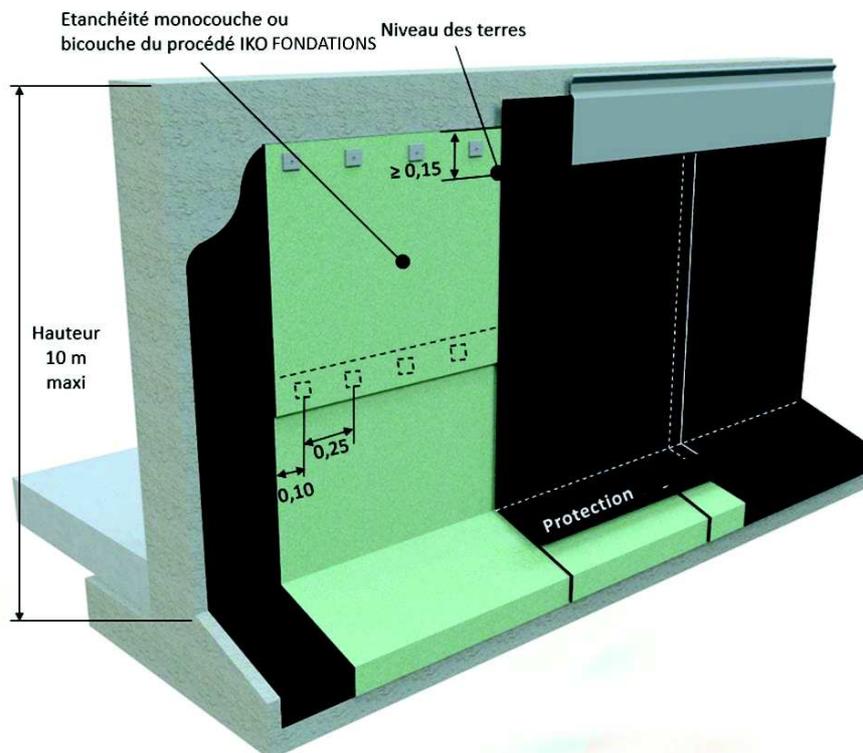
Exemple de mise en œuvre d'une nappe de protection / drainage sur revêtement d'étanchéité
